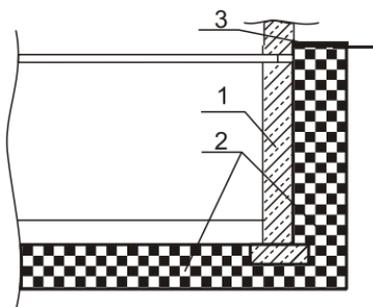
Схема гидроизоляции подземного сооружения:
